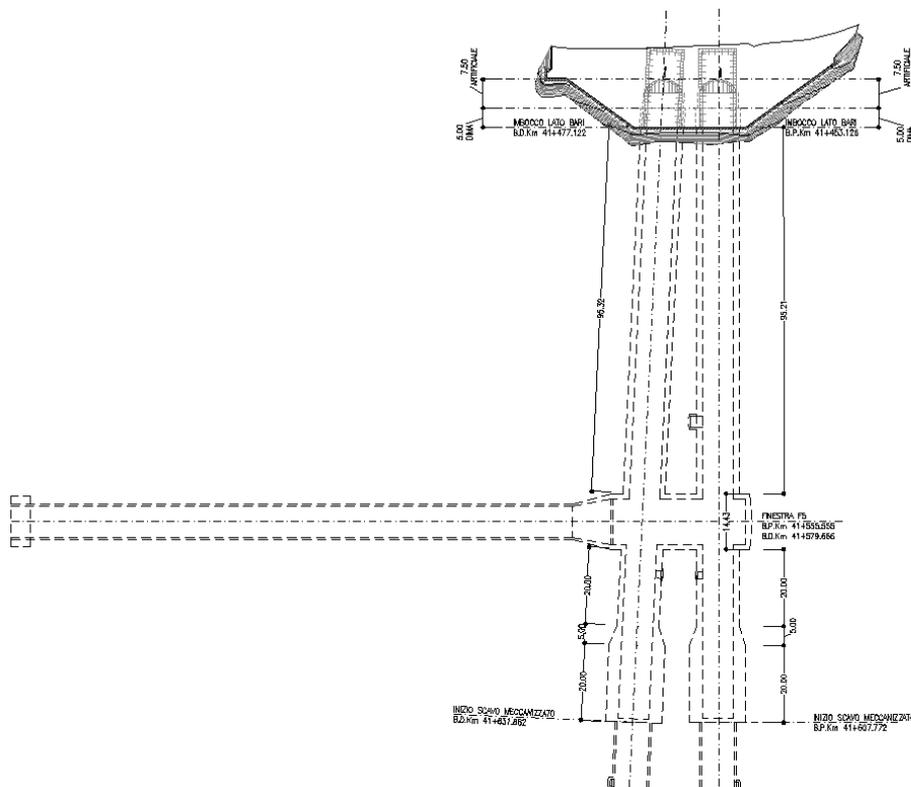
Planimetria imbocco GN Tradizionale imbocco lato Bari
